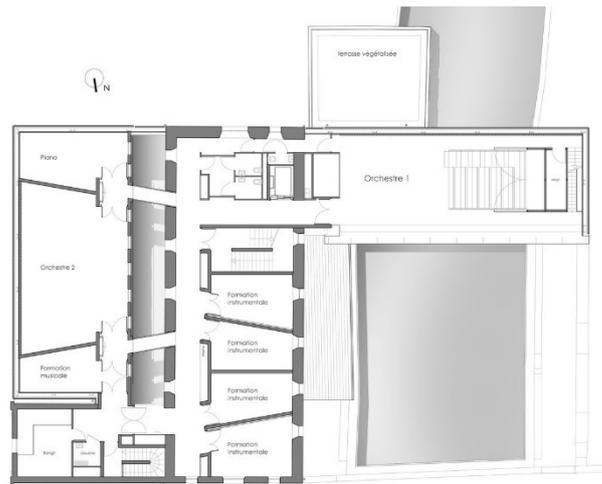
Planta baixa Tèrreo. Fonte: Archdaily, 2013.
